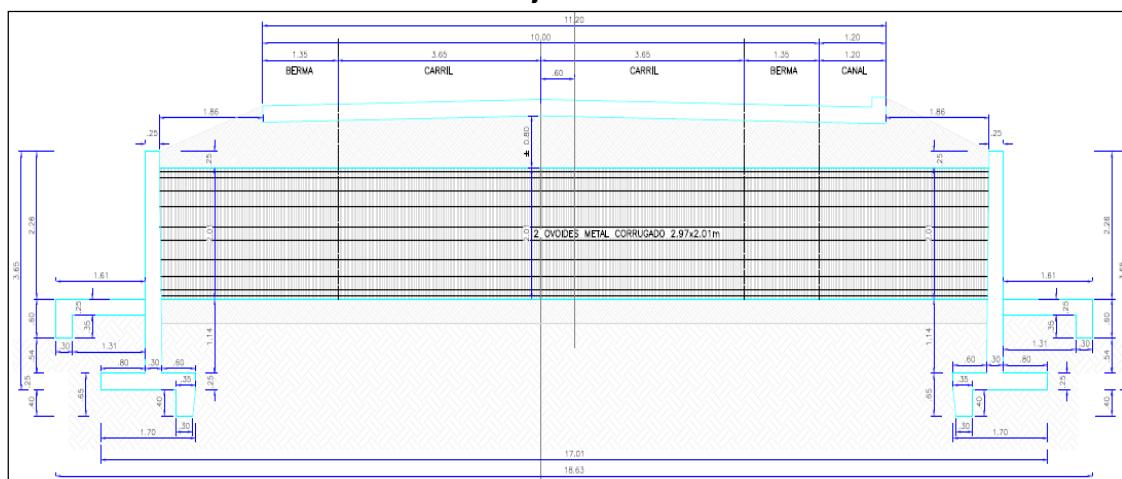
Planos de diseño de planta Box Culvert tubería ovoide metálica corrugada para la obra de drenaje PR81+190
